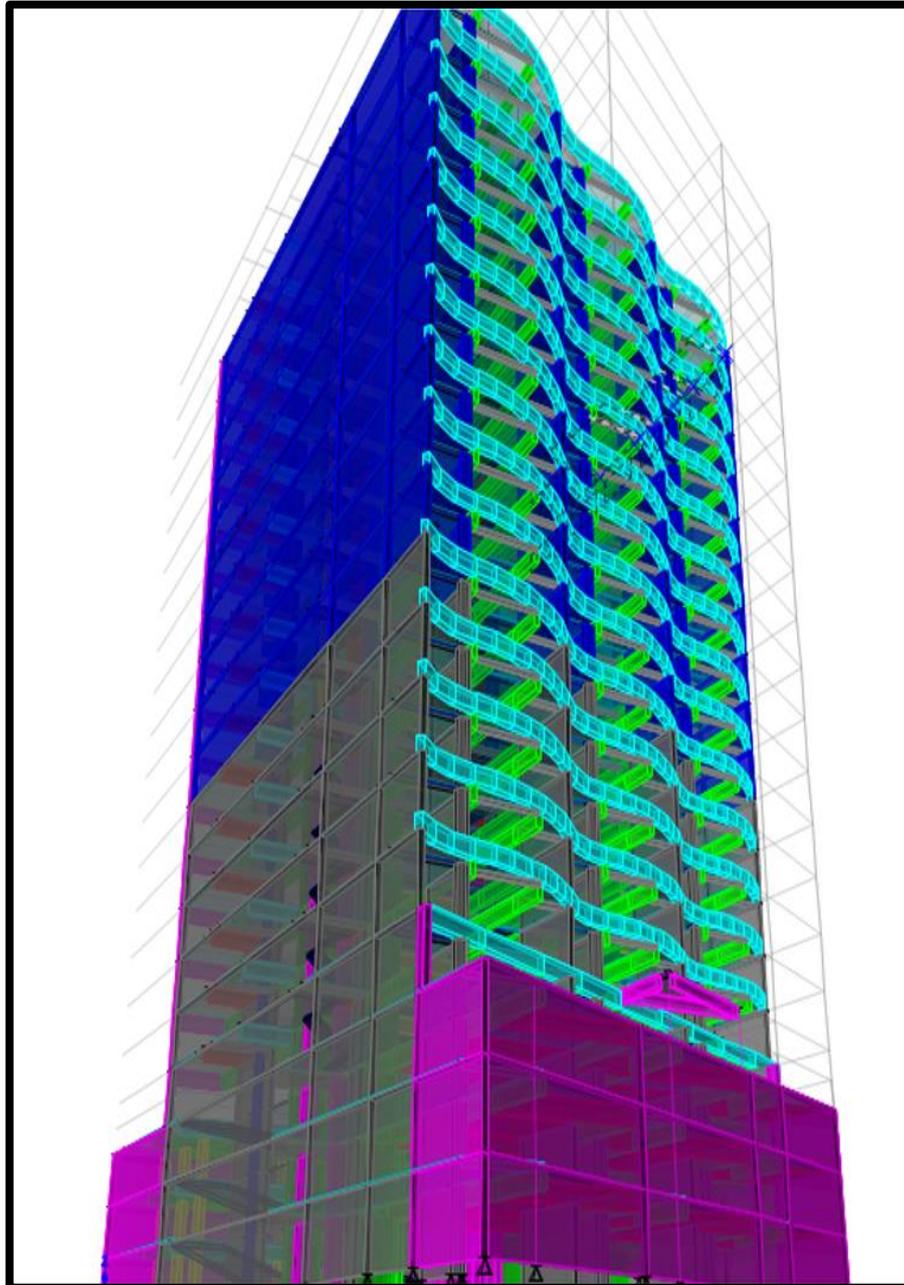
Modelación vista 2 del proyecto: “Edificio Meridian”.
